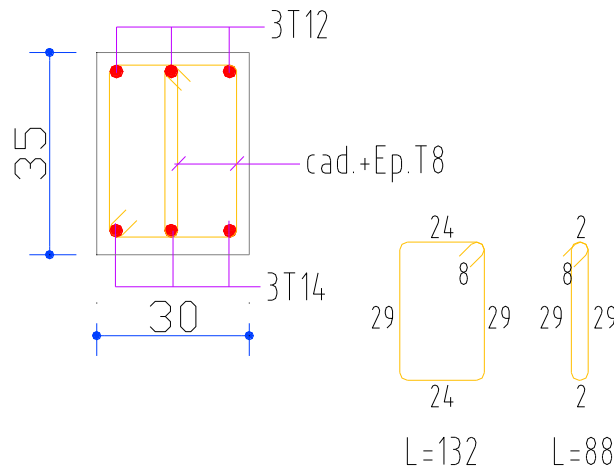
Ferrailage des poutres secondaires au niveau de travée de niveaux RDC et terrasse.
